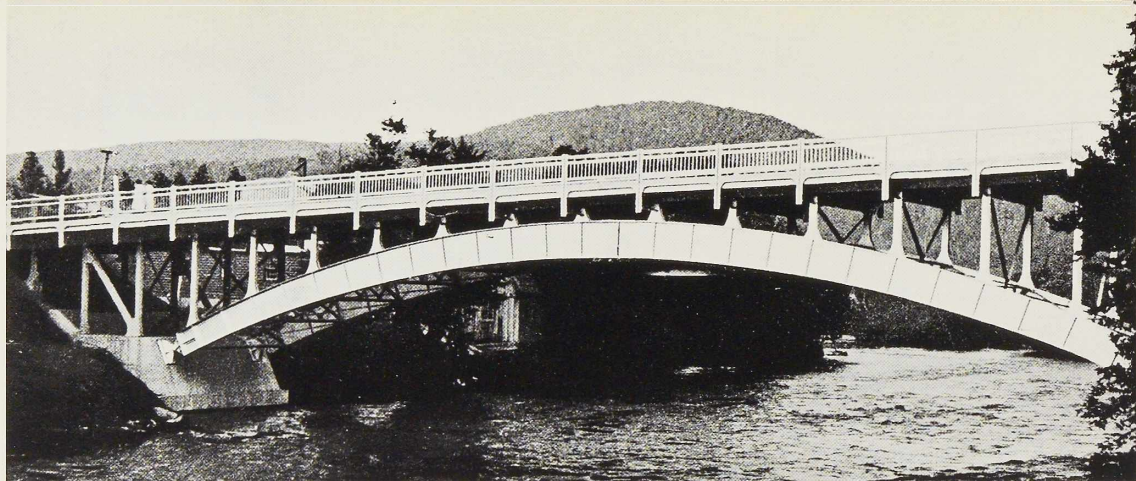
Pont « West Stewartown bridge » sur le Connecticut de 41^m40 de portée (New-Hampshire).
